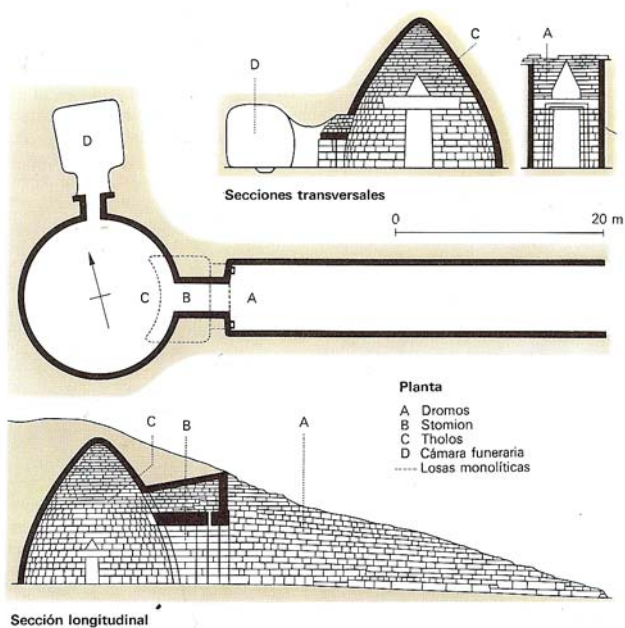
Tesouro de Atreu, Plantas e Cortes
